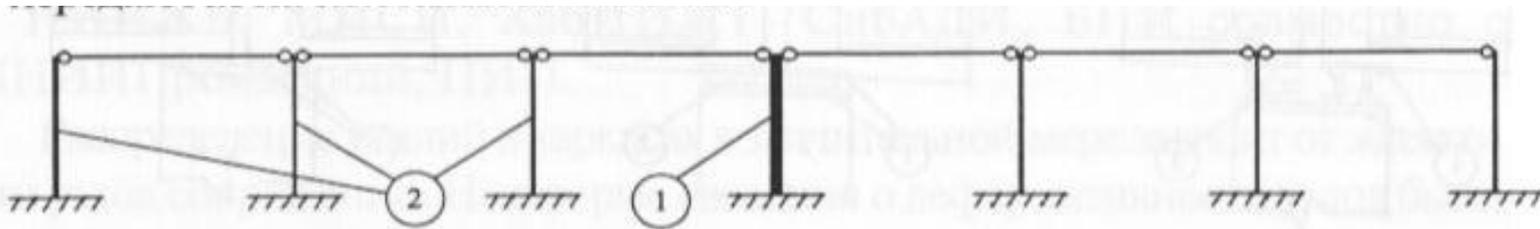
Схема связевого каркаса: 1 — элемент жесткости; 2 — рядовые колонны
